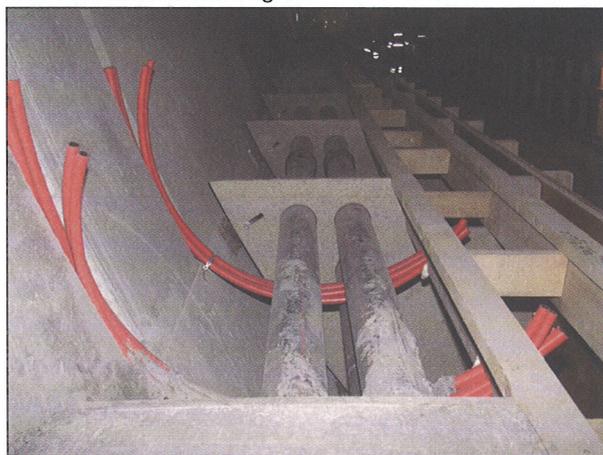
Fixation der 15kV-Leerrohre mittels Kunststoffbetonplatten
